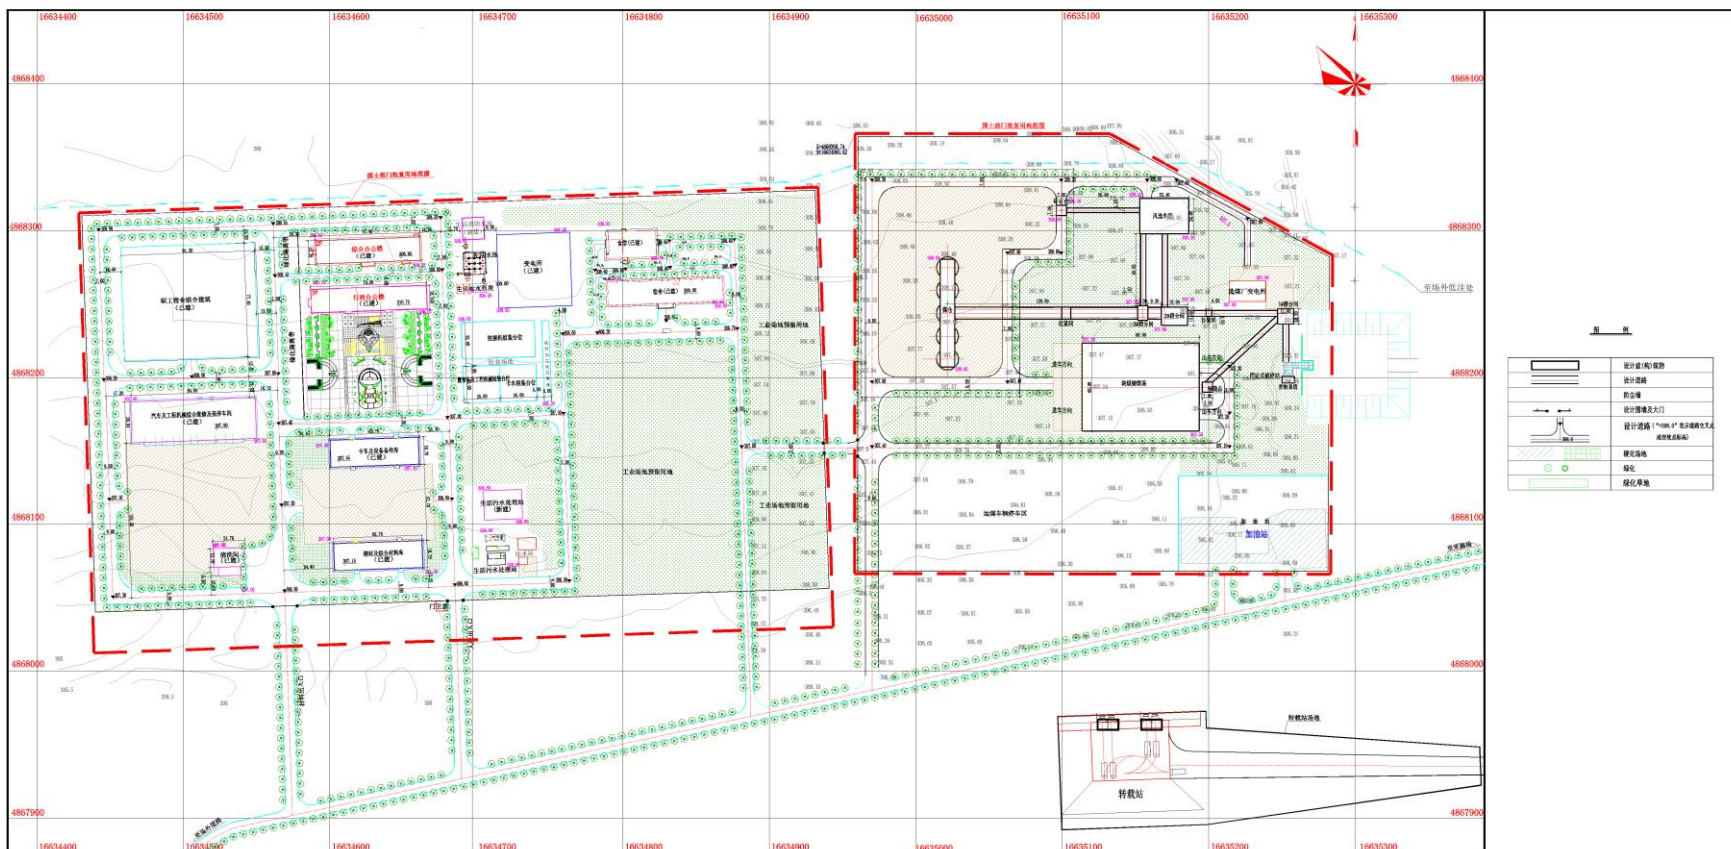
工业场地及选煤厂(含加油站)总平面布置
